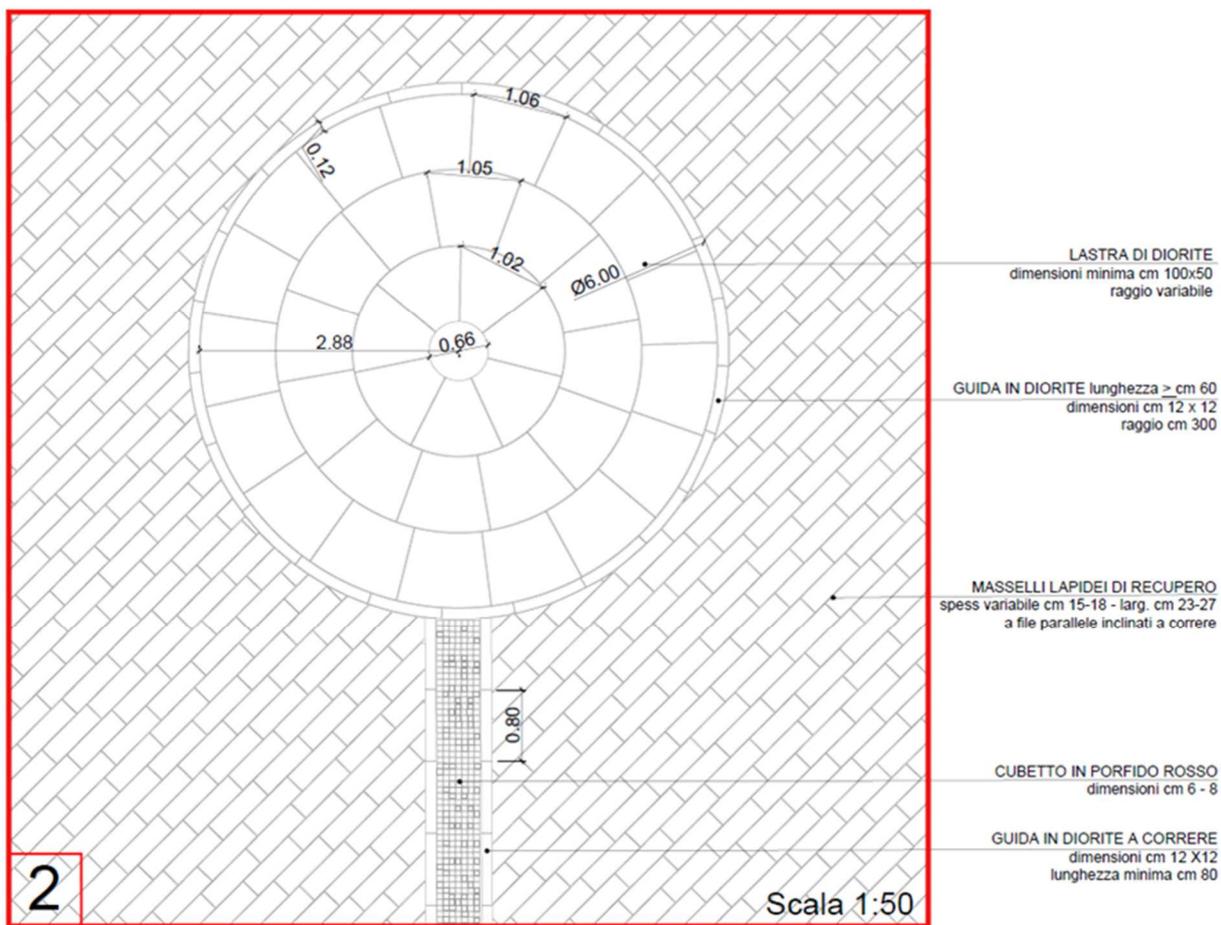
Lotto 1 Piazza particolare 2 pavimentazione
